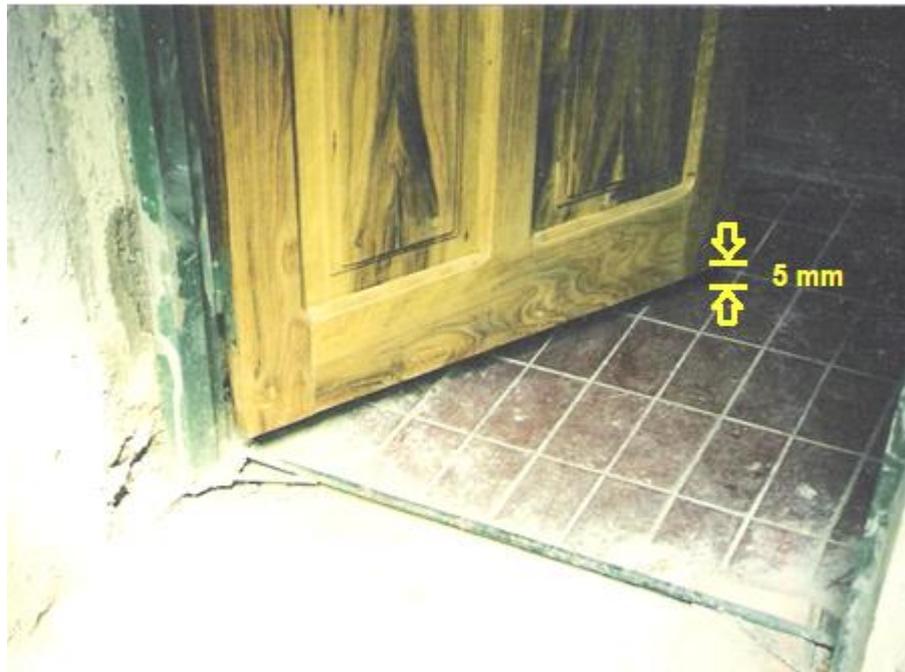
Separación de puertas del Nivel de Piso Terminado. (Observar separación excesiva de 5 cm entre piso y hoja)
